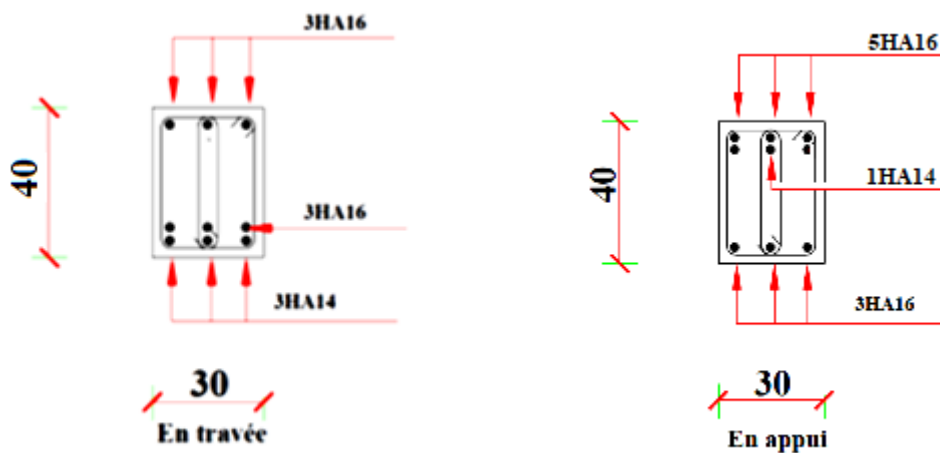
Croquis de ferrailage de la poutre principale 2
